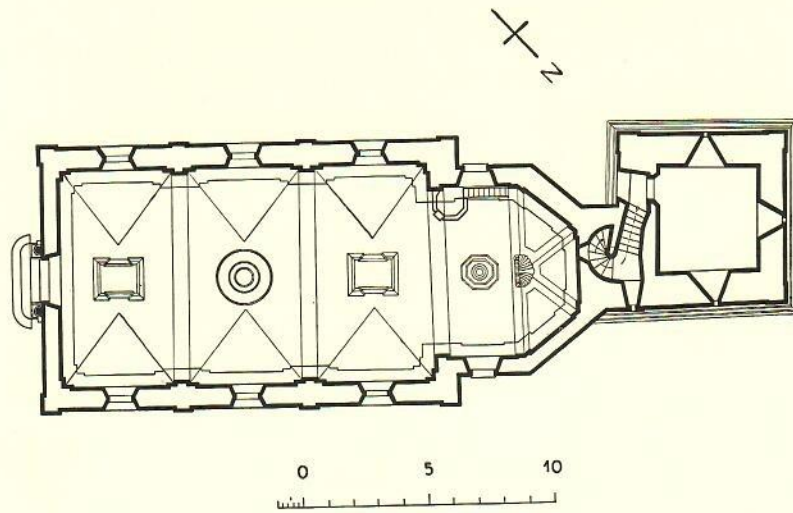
Grundriss. — Maßstab 1 : 300. — Vgl. den Längsschnitt Abb. 328, S. 336.
